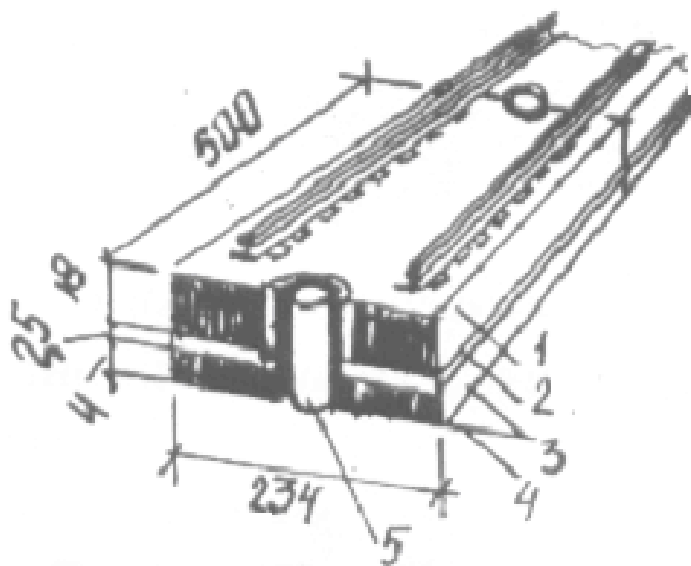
Безбалластное мостовое полотно из сборного железобетона (Япония): 1 – железобетонная плита; 2- резиновая прокладка; 3 – асфальтобетонная инъектированная смесь; 4 – проезжая часть;
